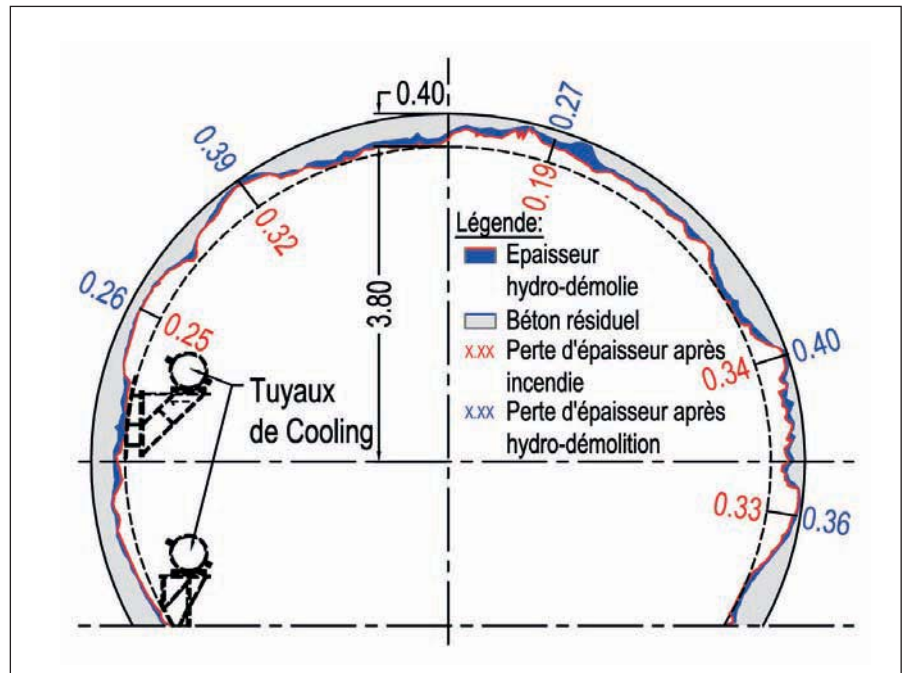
Exemple de coupe transversale du tunnel Nord après incendie.
